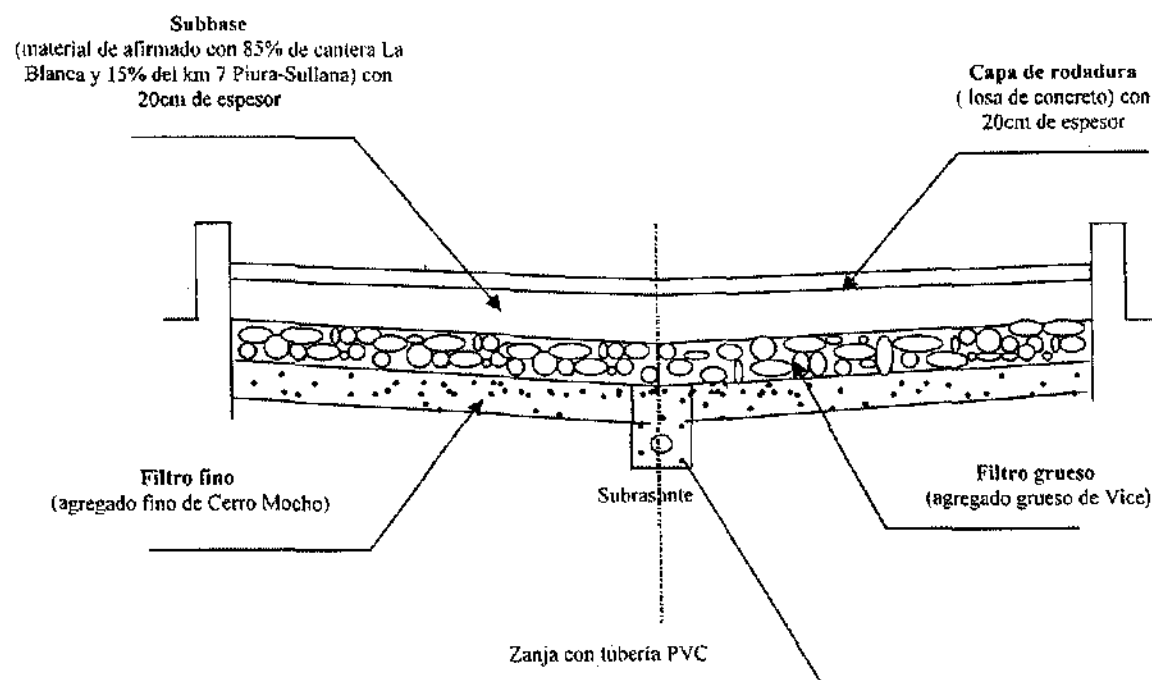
Pavimento con subbase, filtro fino y filtro grueso
